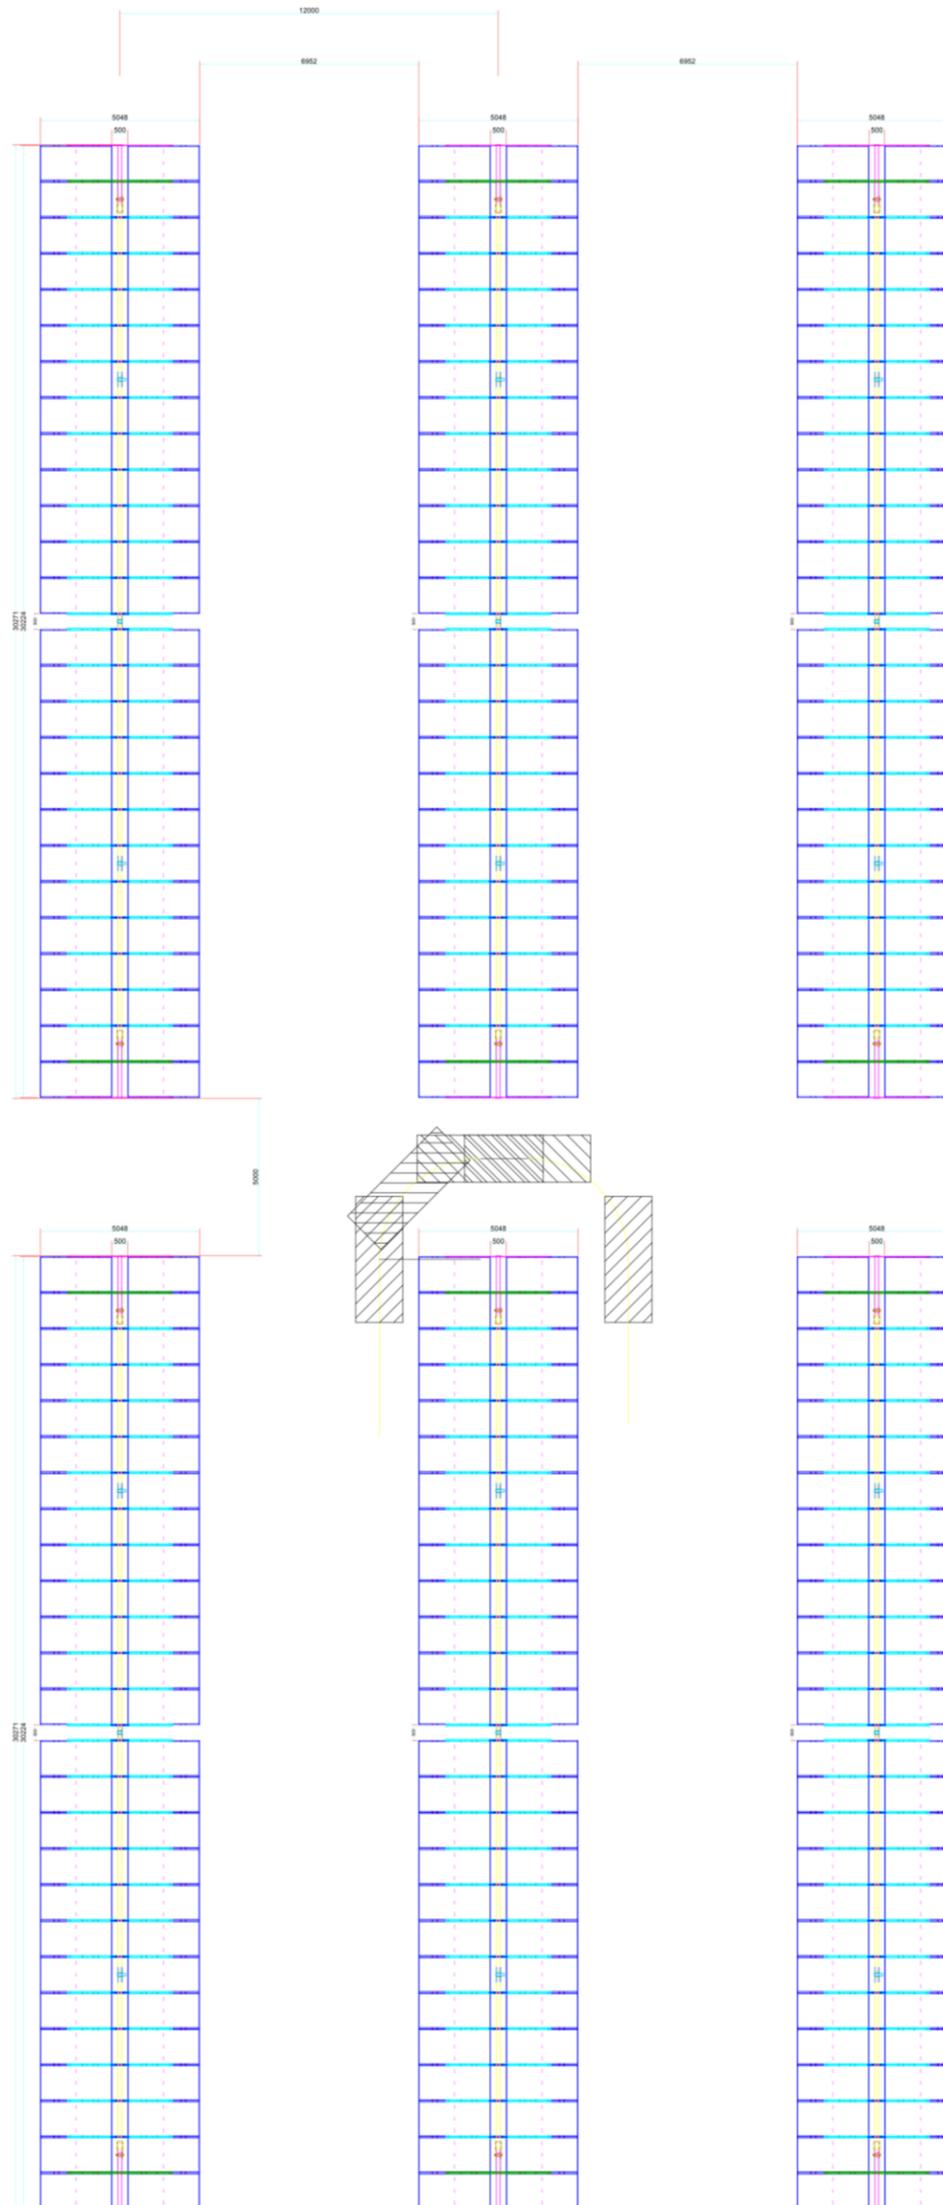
layout impianto (stralcio) con interasse 12 m e corridoi da 5 m
